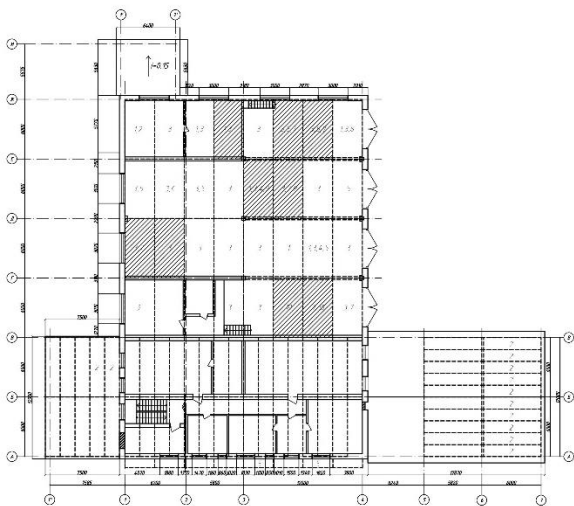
Схема раскладки плит покрытия с выявленными дефектами
